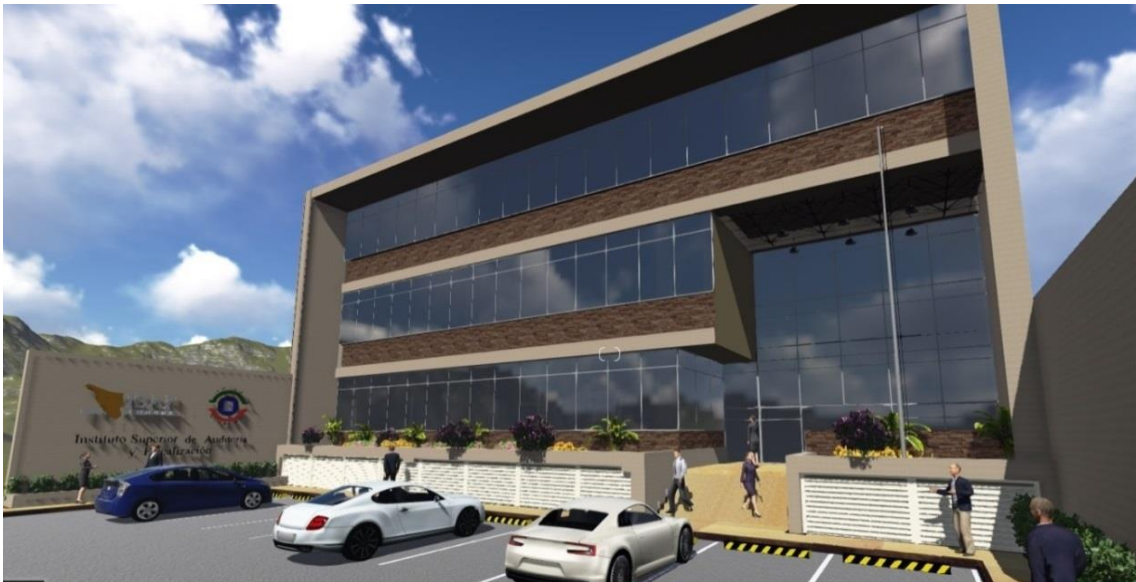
Fachada Principal. Esta imagen corresponde a la propuesta elegida por el cliente. Autor: Carmen López.
